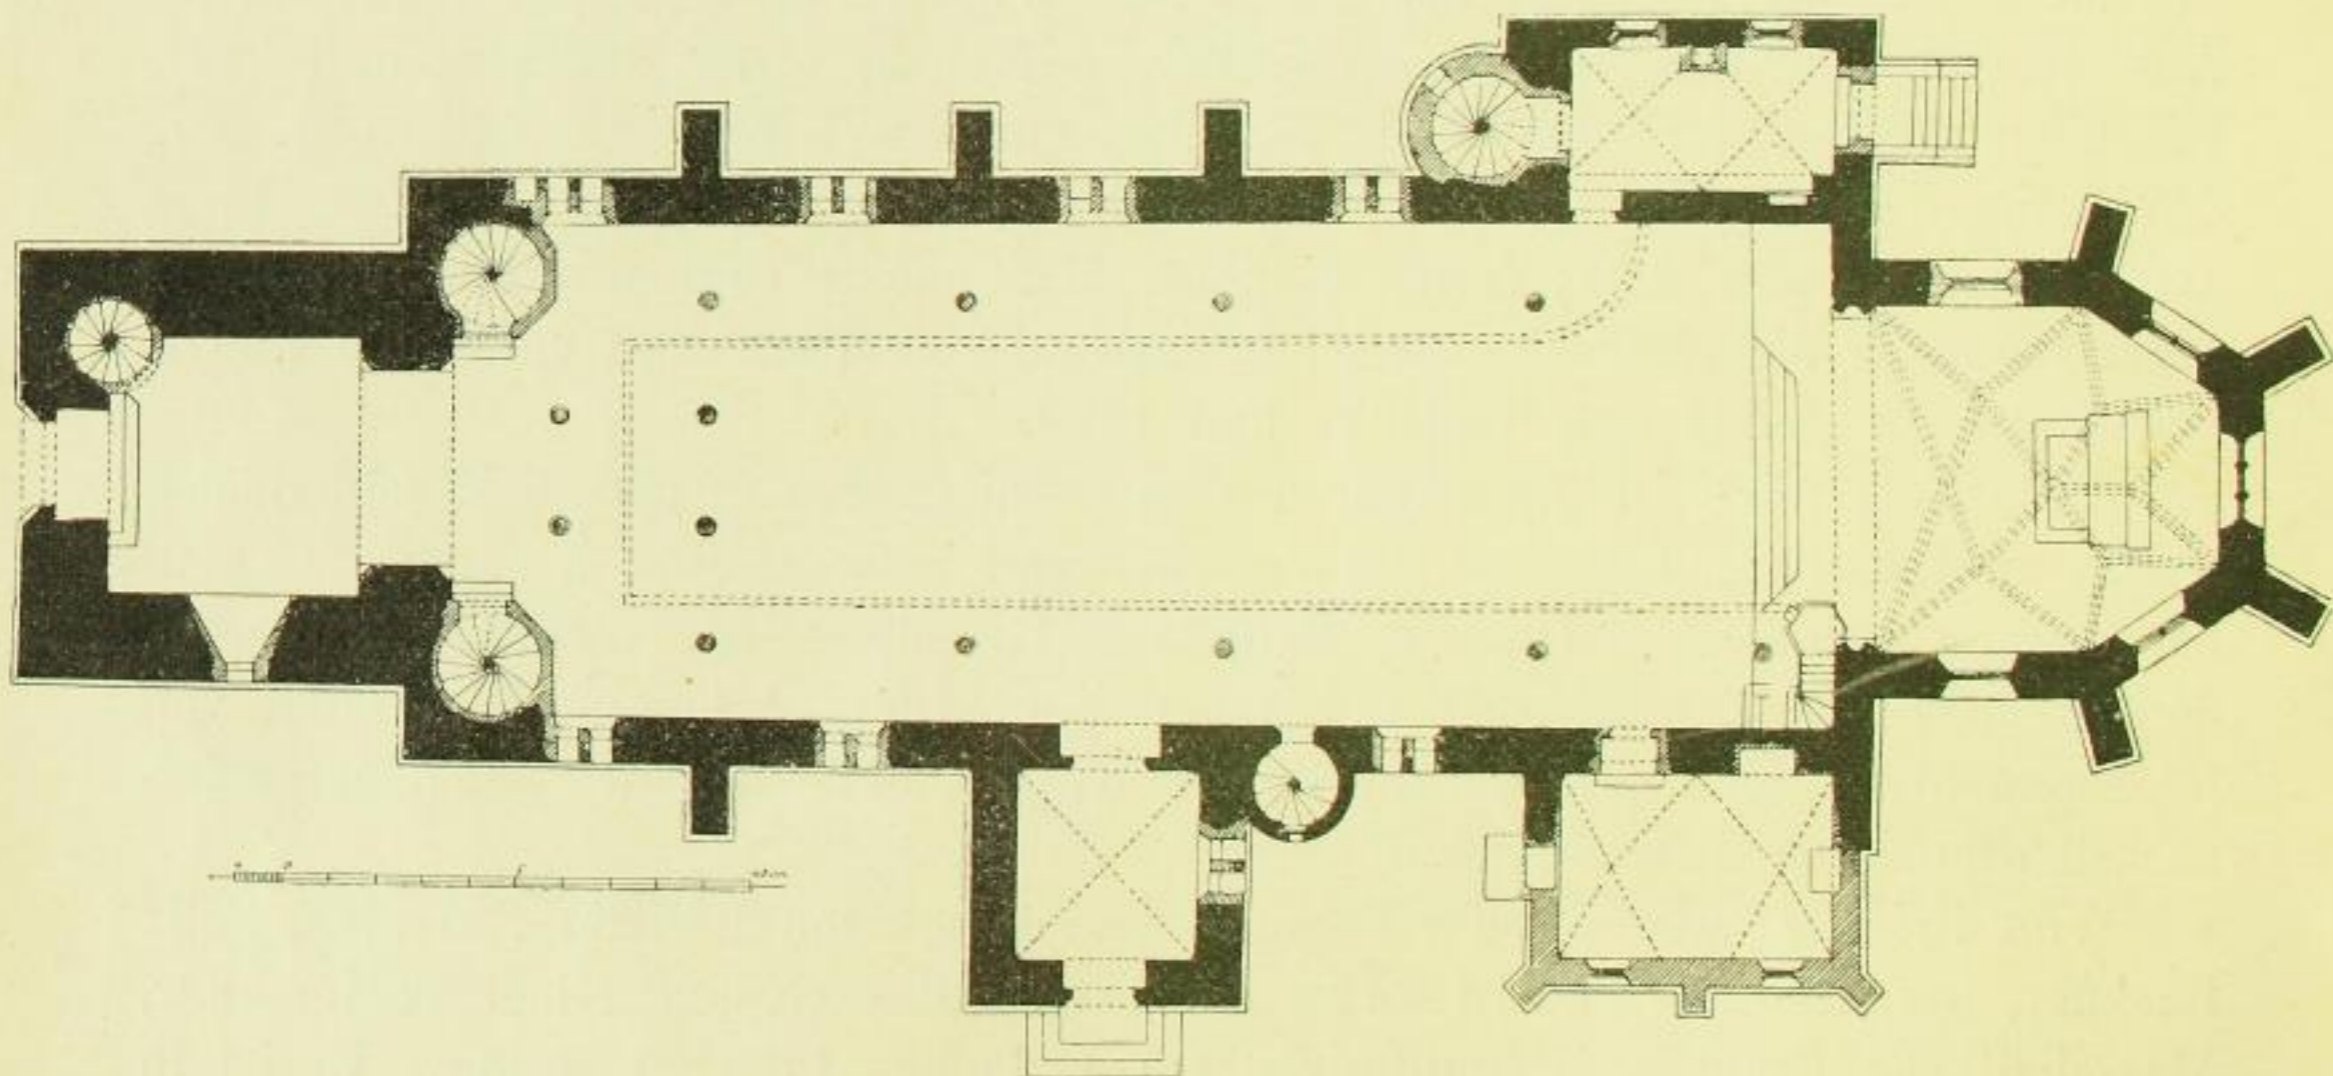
Briessnitz, Grundriss der Kirche.
